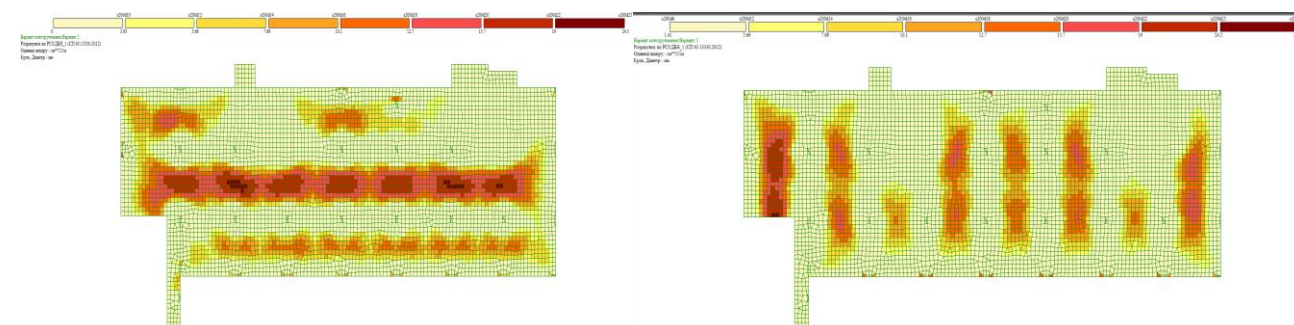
Мозаїка нижнього армування плити перекриття товщиною 350 мм та маркою бетону В30 по осі X,Y
